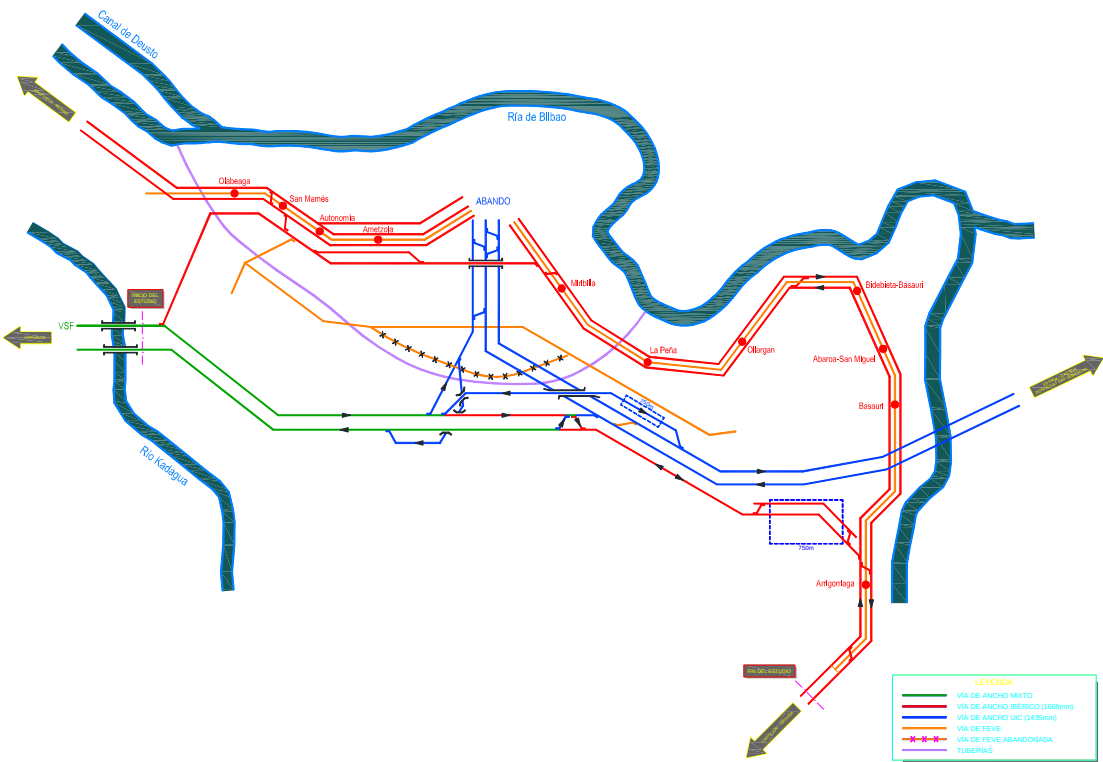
Planta de conjunto de la Alternativa 1 aprobada (E.I. VSF Fase II, en redacción).
